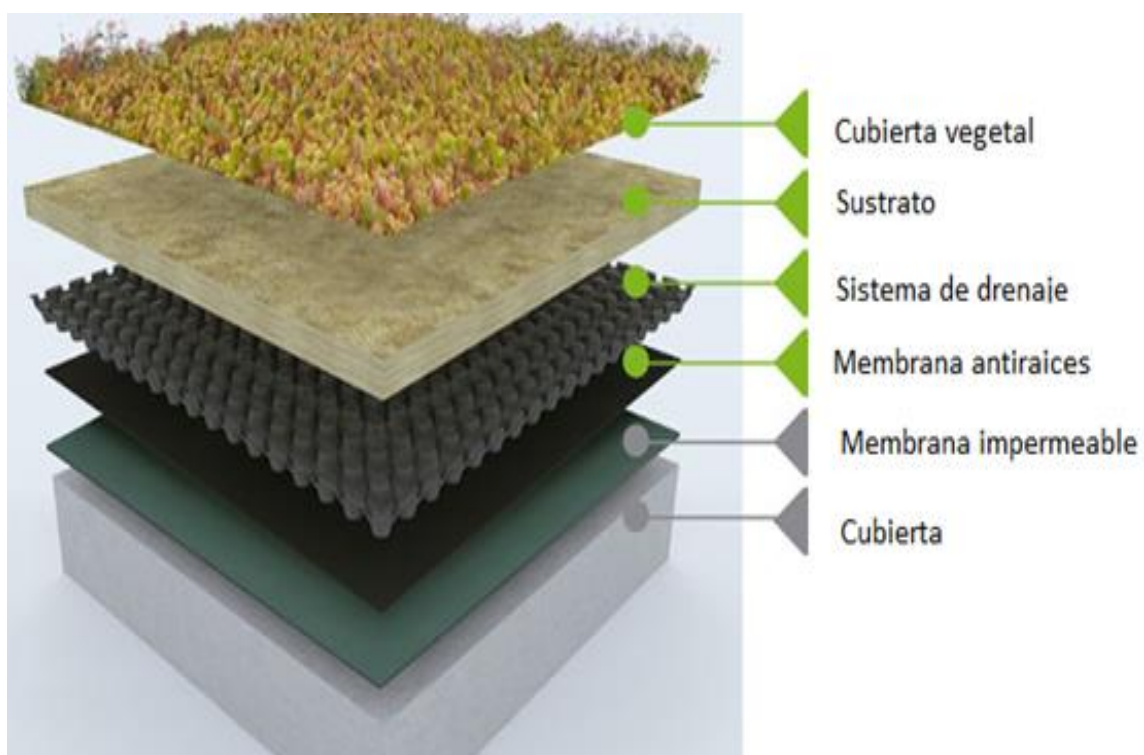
Sección transversal de cubiertas verdes www.construible.es
